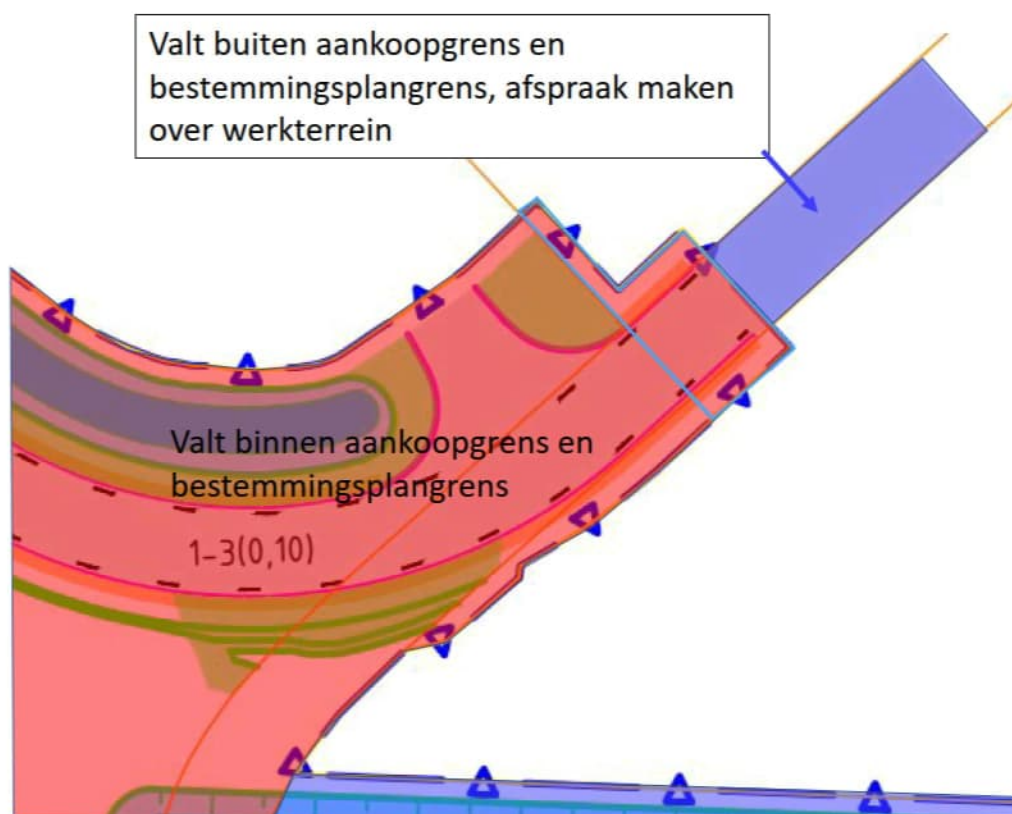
Verbeelding ontwerp met plangrens en aangepaste bestemmingsplan- en aankoopgrens
